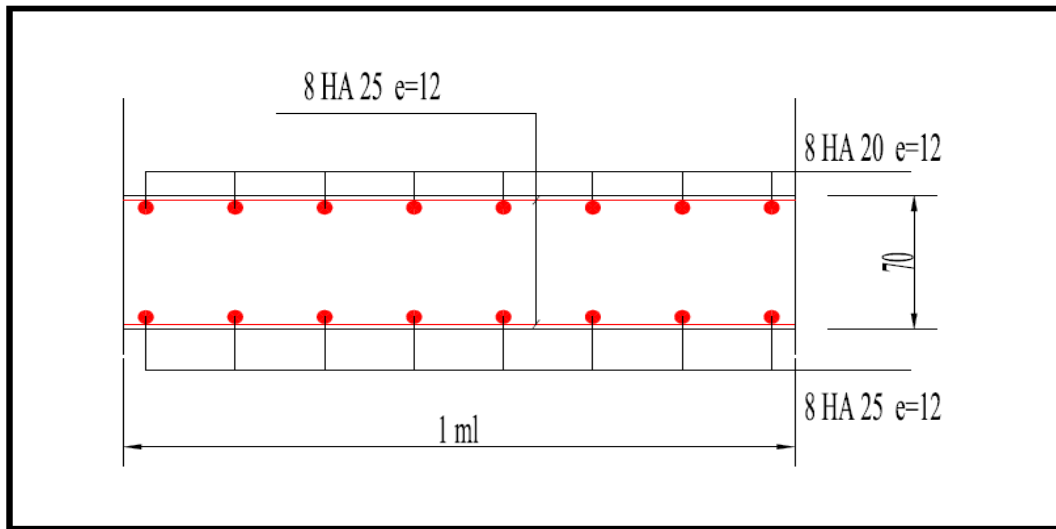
Ferrailage de la dalle du radier (sens xx).
